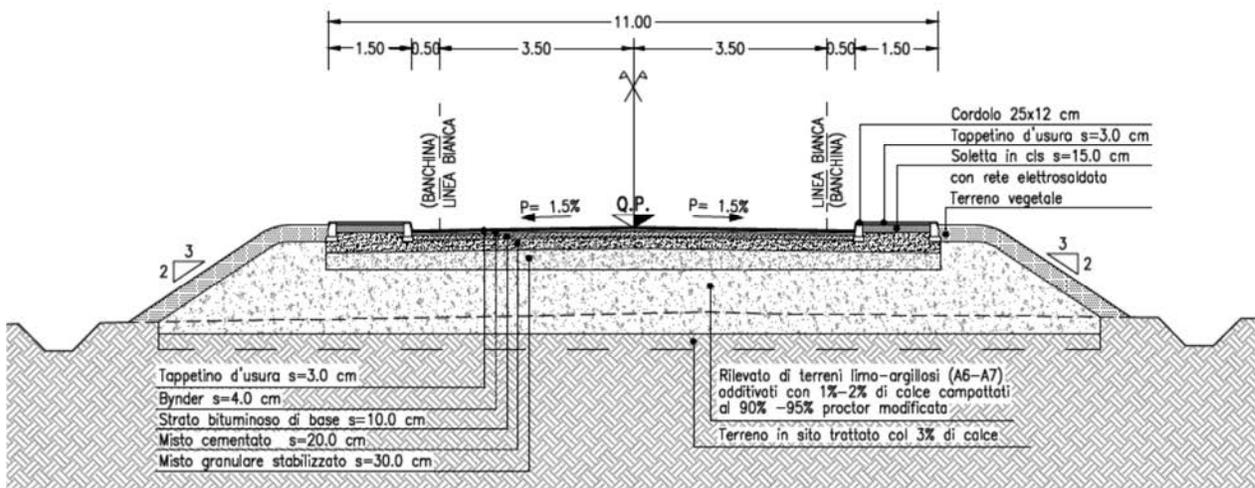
d – sezione tipo della carreggiata di tipo E1
